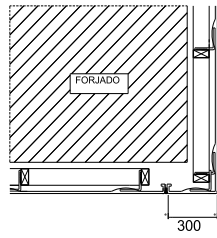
DETALLES ENCUESTRO Y COMPOSICION FACHADA- PANELES STUD- FRAME GRC.
